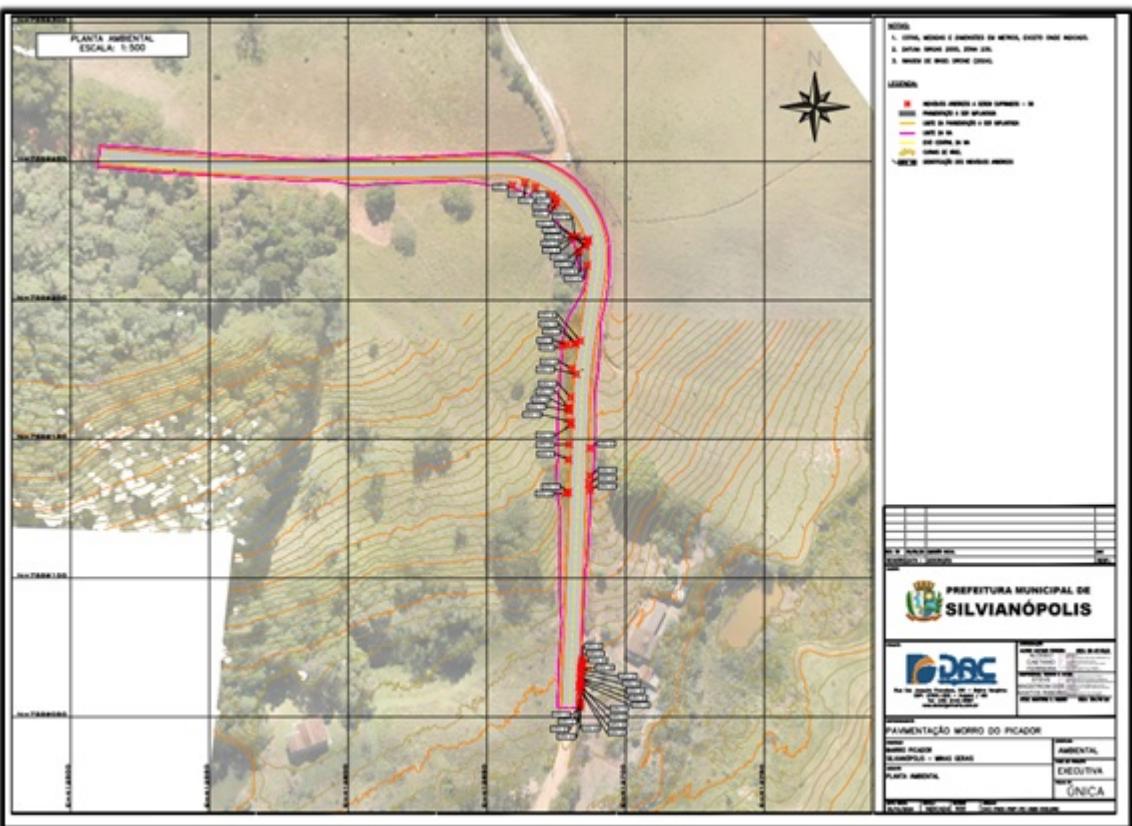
e 2 - Croqui da área solicitada para intervenção - Estrada Municipal Bairro do Picador
